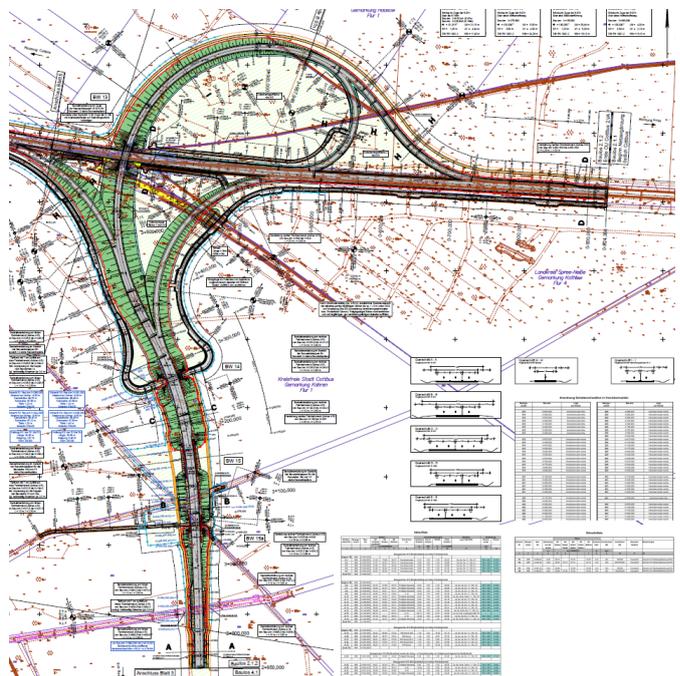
Lageplan Baulos 2, neuer Knotenpunkt B 168 B 97n, Karte: LS
